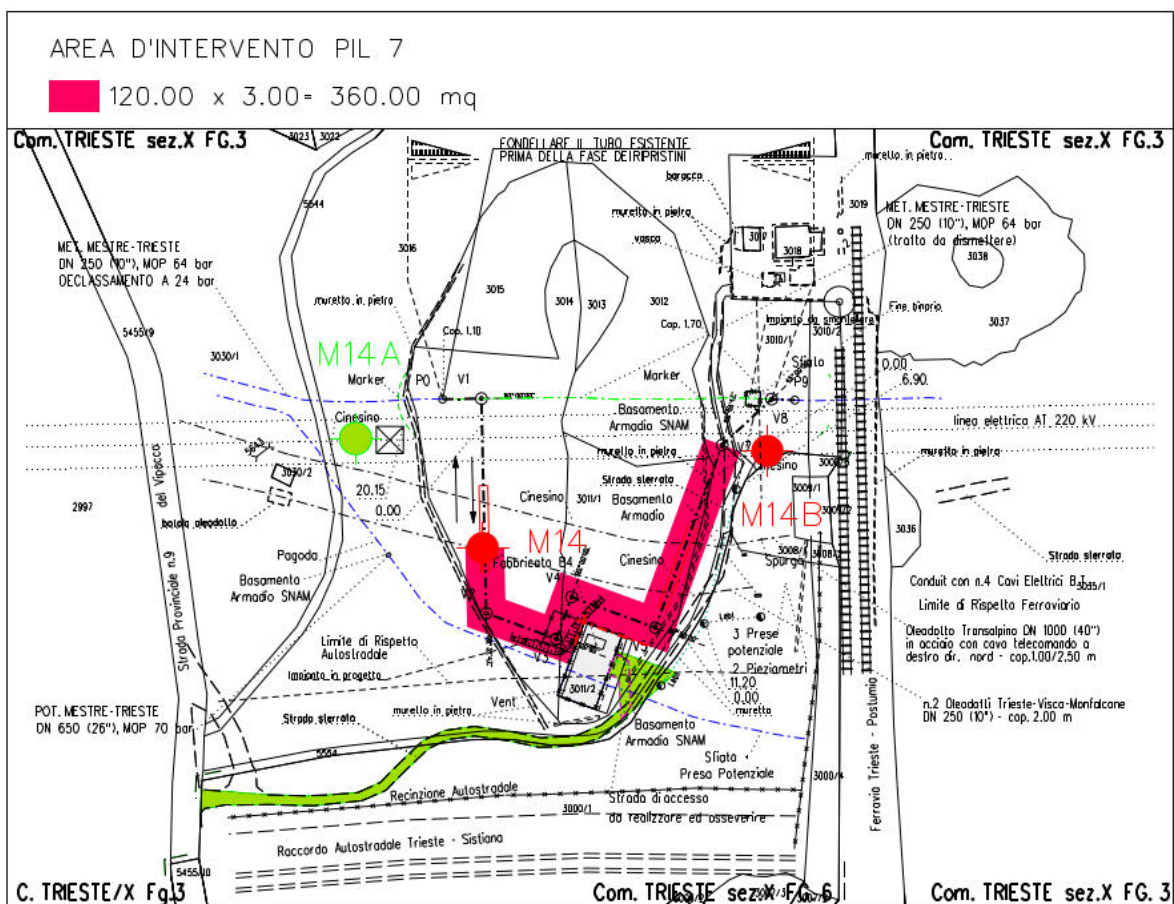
Stralcio planimetro area d'intervento, con indicata in rosso l'area interessata dallo scotico
